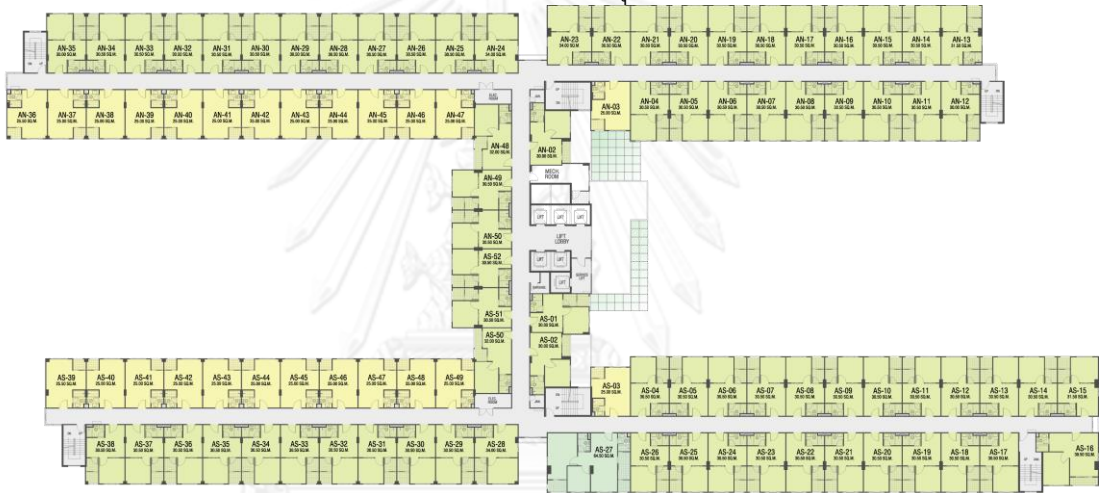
14 แสดงผังพื้นชั้น Ground ของโครงการลุมพินี วิลล์ รามอินทรา-หลักสี่
